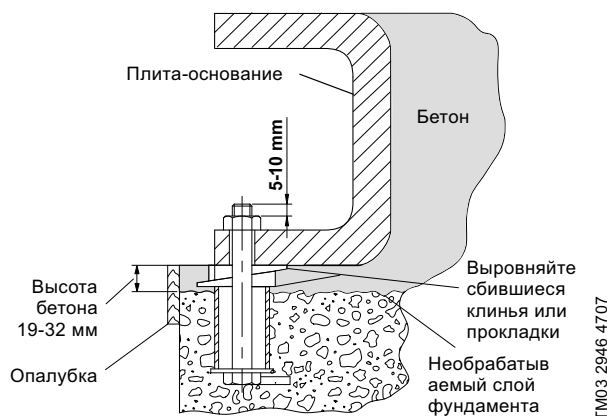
Фундамент с установленными фундаментными болтами, бетонной заливкой и плитой-основанием
